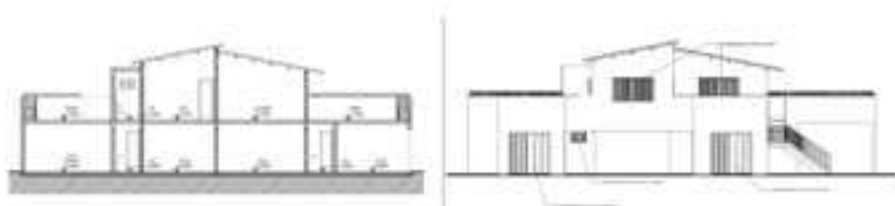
Corte transversal e Fachada frontal das casas geminadas. Fonte: Produzida pelos autores (2011).
